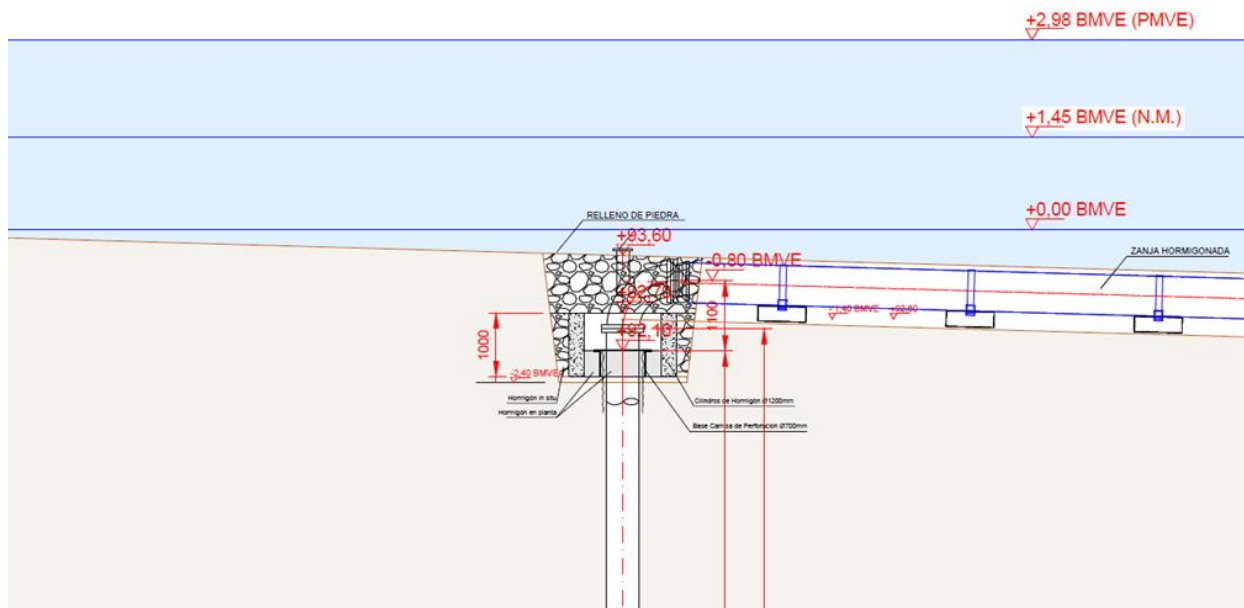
Detalle de ejecución del Sondeo de Conexión a la Galería 1
